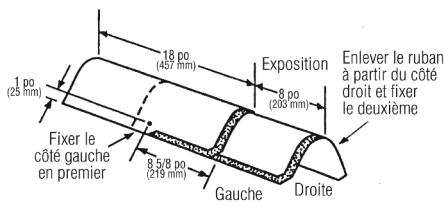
Pose de bardeaux de Shangle Ridge sur les arêtes et les faîtes.
